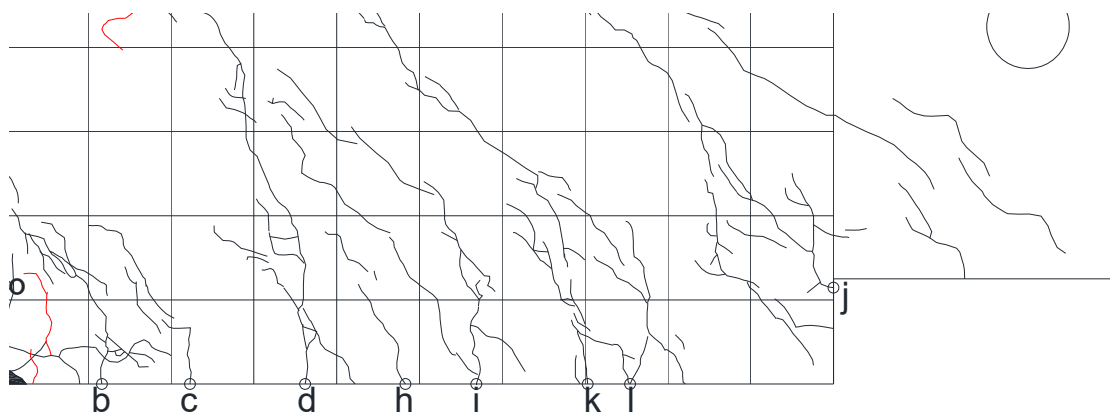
基礎梁ひび割れ測定位置(試験体 E-1 正載荷)
